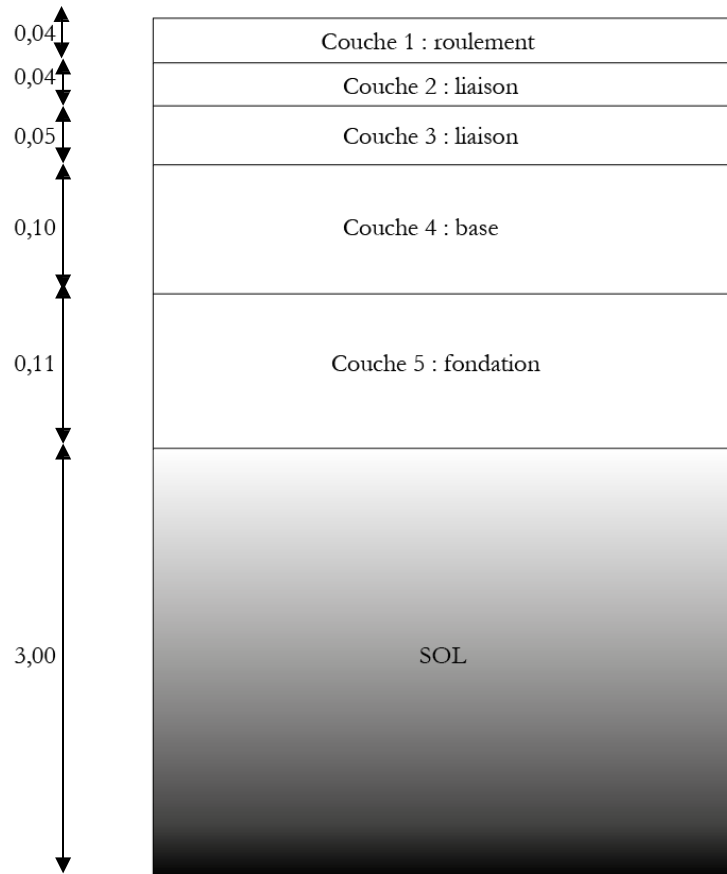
CHAUSSÉE BITUMINEUSE EPAISSE
